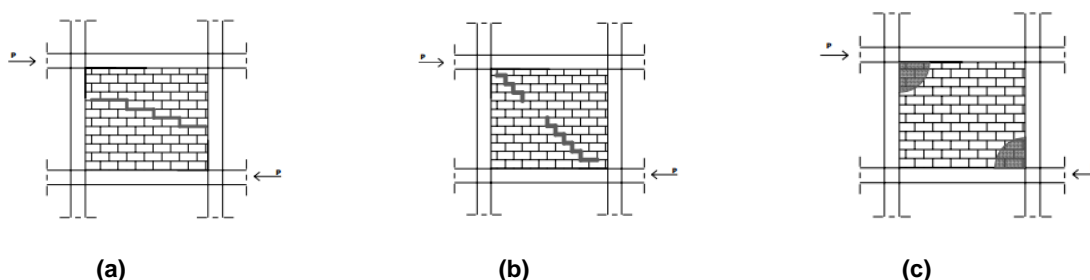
Modos de rotura da alvenaria de enchimento: (a) Rotura ao longo das juntas; (b) Rotura diagonal; (c) Rotura por esmagamento dos cantos comprimidos (retirado de: [34]).
